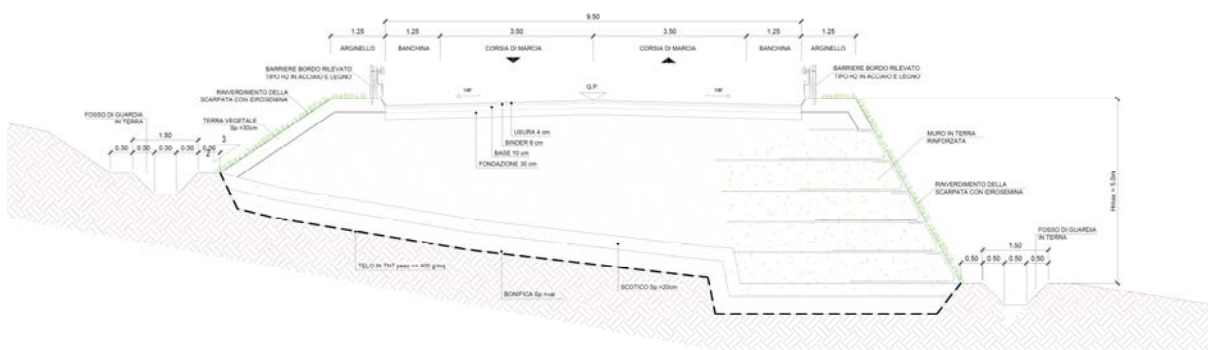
Sezione tipo rilevato stradale con terre rinforzate
